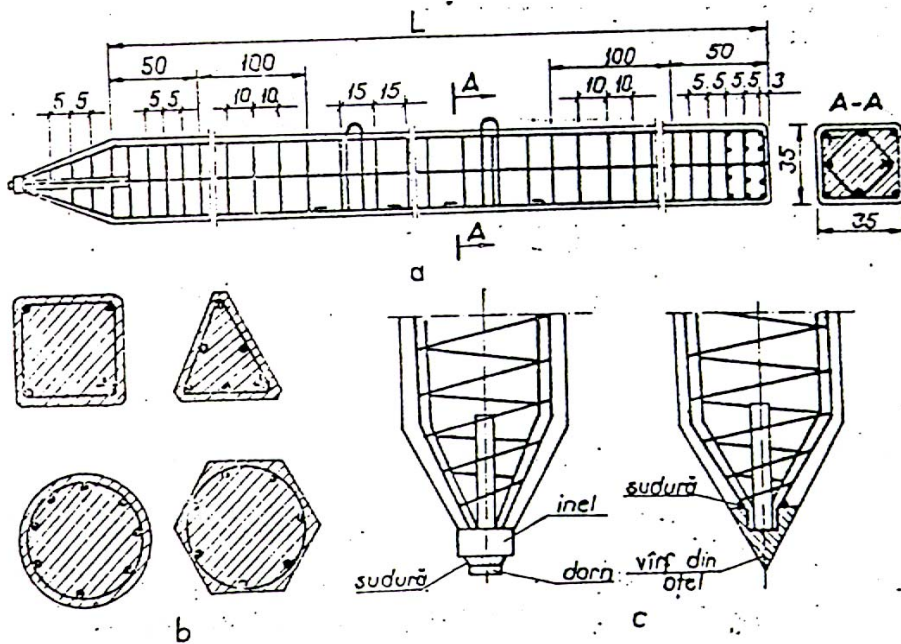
Pilot de beton armat; a- armarea pilotului, b - secțiuni transversale, c- detalii de vîrf. Capul pilotului se armeză cu trei plase
